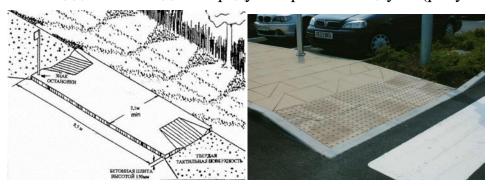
Пример оборудования посадочной площадки пандусами
